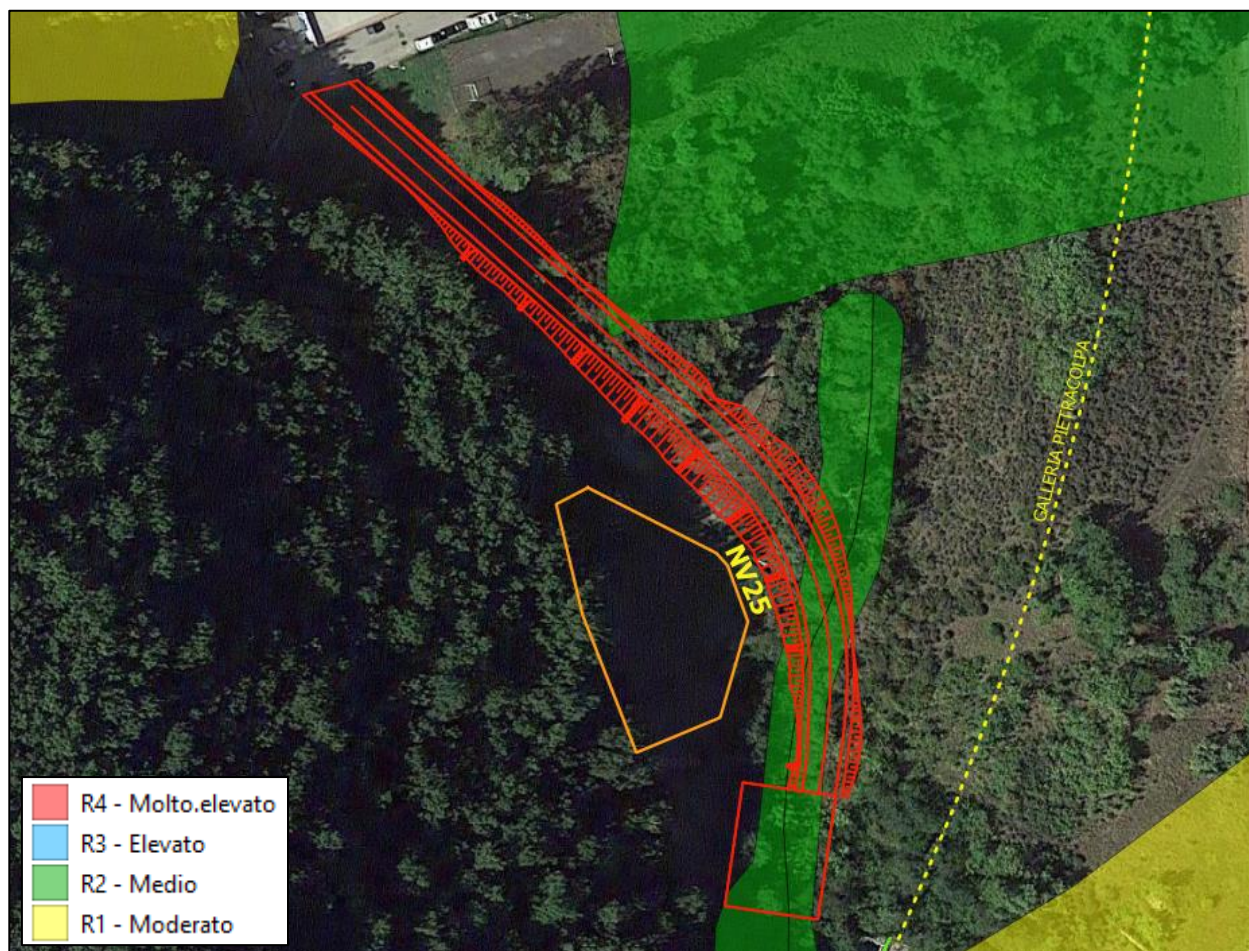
Particolare dell'intervento NV25 - imbocco sud della galleria Pietracolpa.
